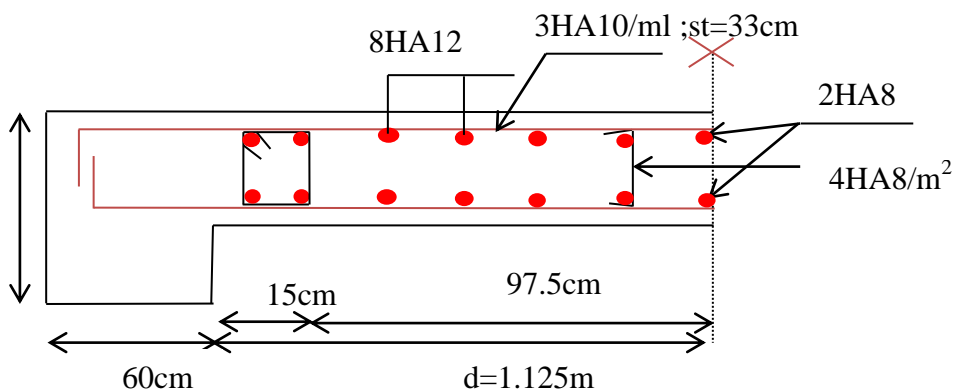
Schéma de ferrailage du voile RDC Vx
